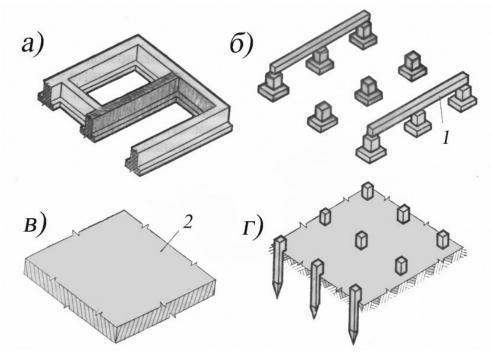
Конструктивные схемы фундаментов: a— ленточный, б— столбчатый, в— сплошной, г— свайный; 1— железобетонная фундаментная балка, 2— железобетонная фундаментная плита
